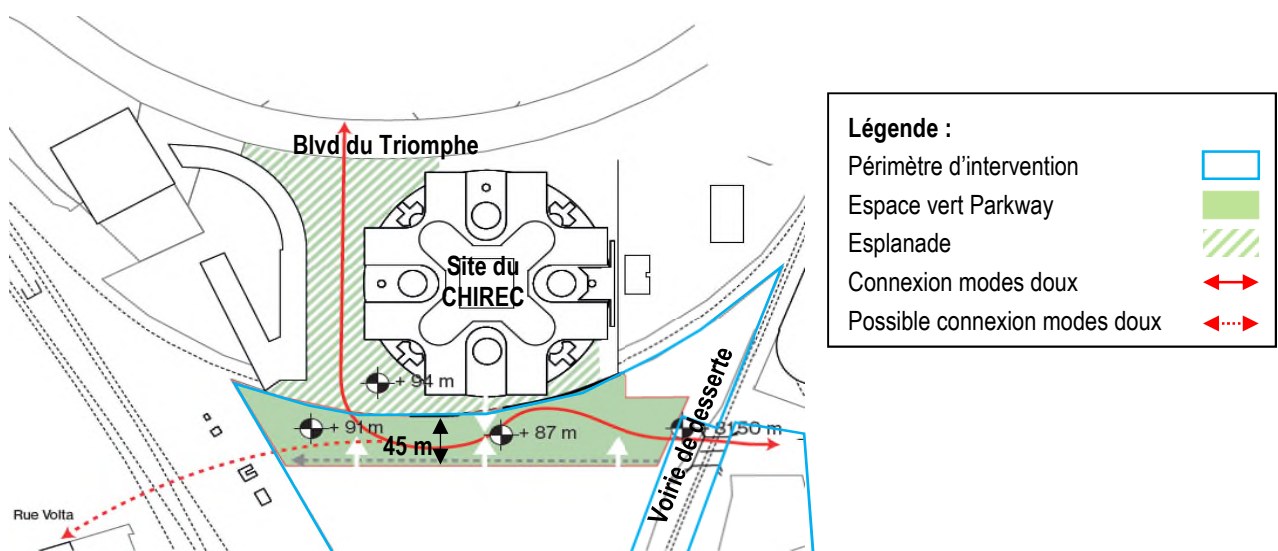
Aménagement en plan du parkway (ARIES sur fond ORG², 2018)
